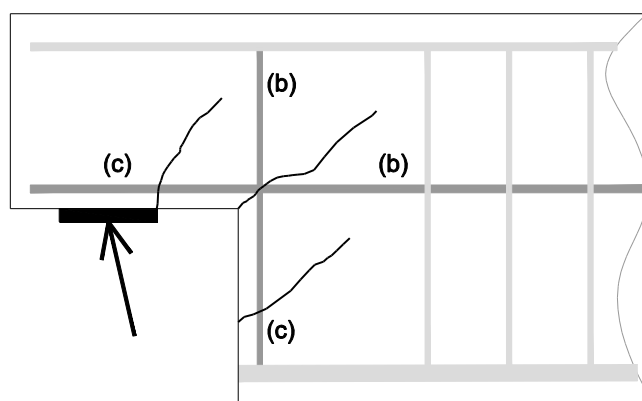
Clasificación de los extremos de las armaduras en función de la fisuración adyacente
